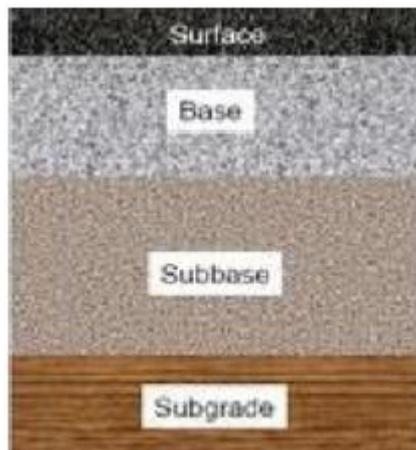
Seção Transversal do Pavimento Permeável (KUMAR, 2014, p.26).
